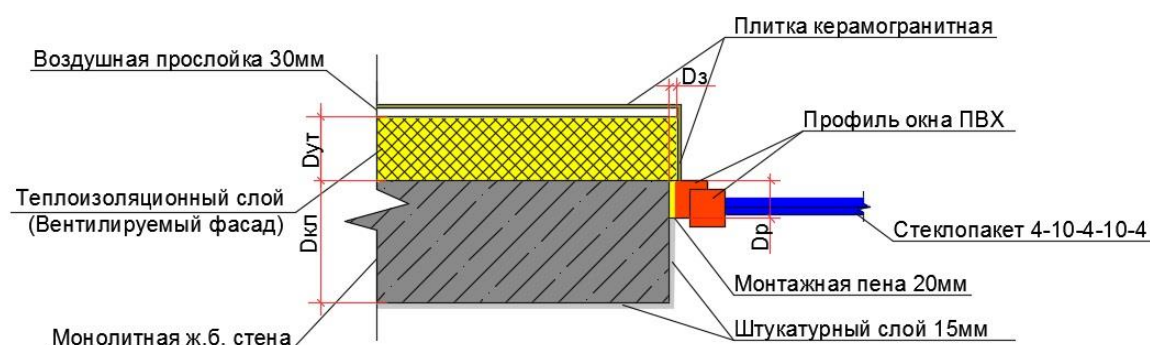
Монолитная стена с наружным утеплением типа вент. фасад
